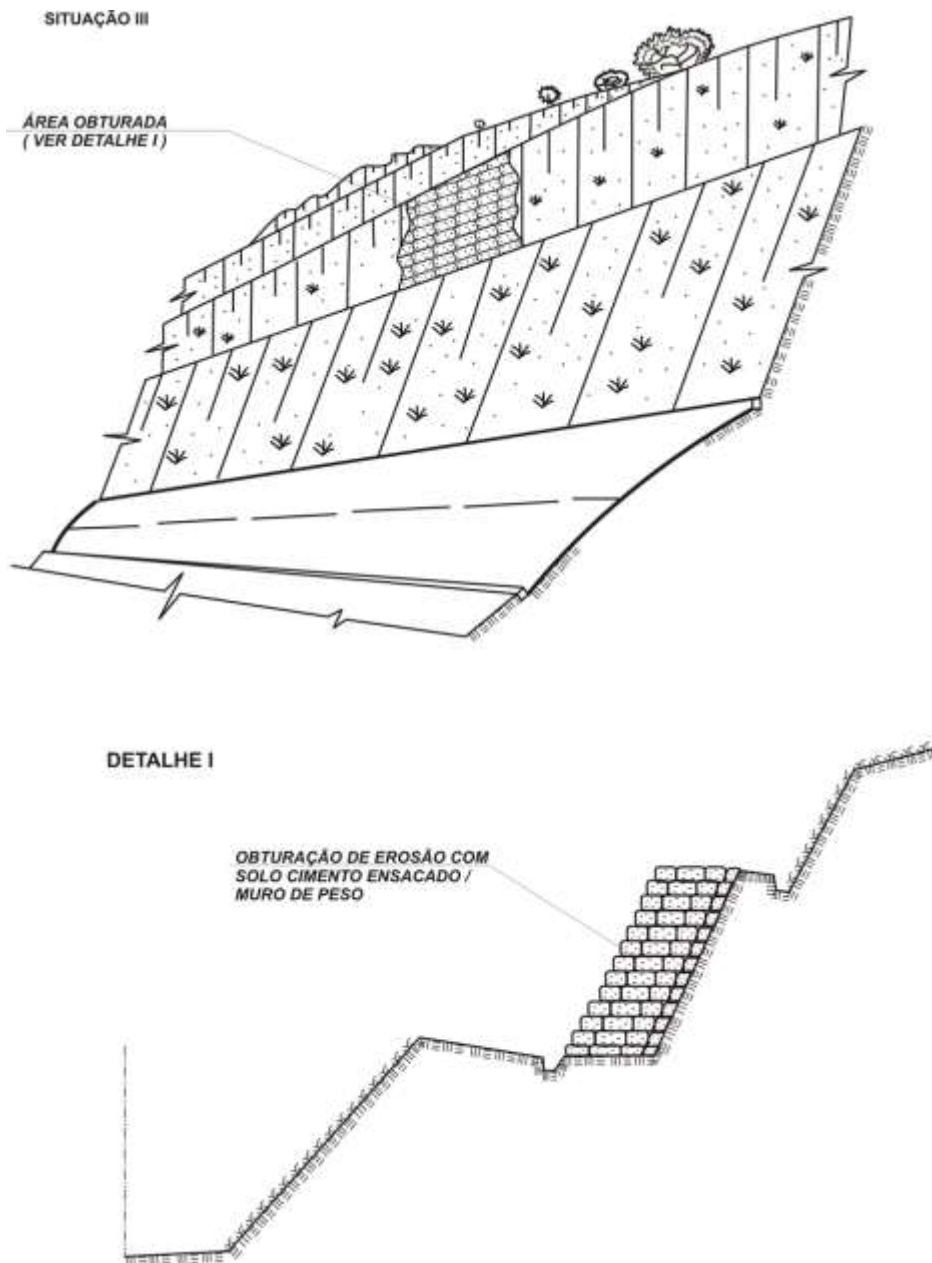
Projeto tipo 9 - Solo-cimento ensacado (situação III).
